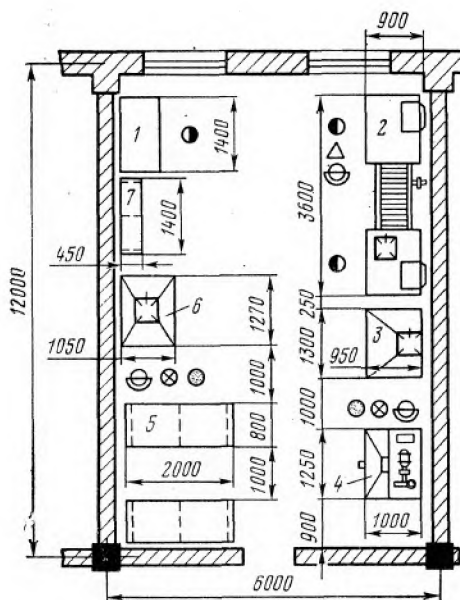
Медницкое отделение ПАТ: 1 – верстак для ремонта топливных баков; 2 – стенд-верстак с ванной для ремонта радиаторов на два рабочих места; 3 – вытяжной шкаф для распайки и протравки радиаторов; 4 – установка для очистки радиаторов от накипи; 5 – стеллаж для радиаторов и топливных баков; 6 – установка для выпаривания и промывки топливных баков; 7 – стеллаж для деталей
